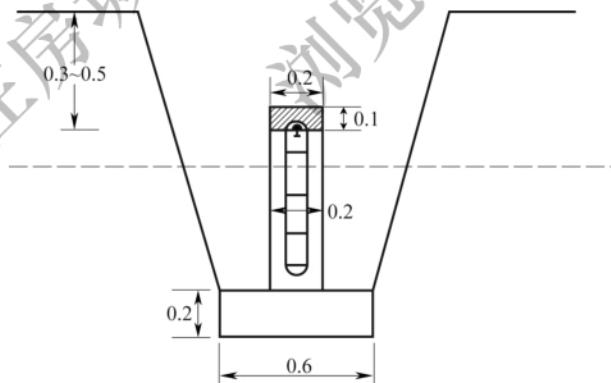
混凝土柱普通水准标石(单位:m)
